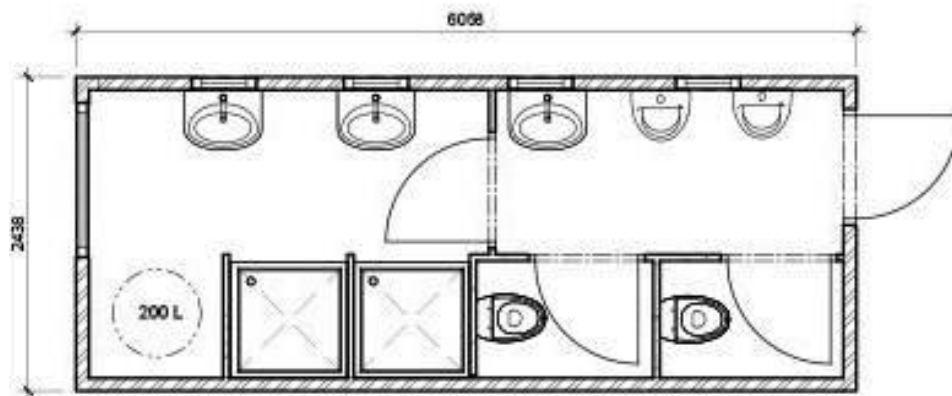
Půdorys kontejneru BK2 TOI TOI
